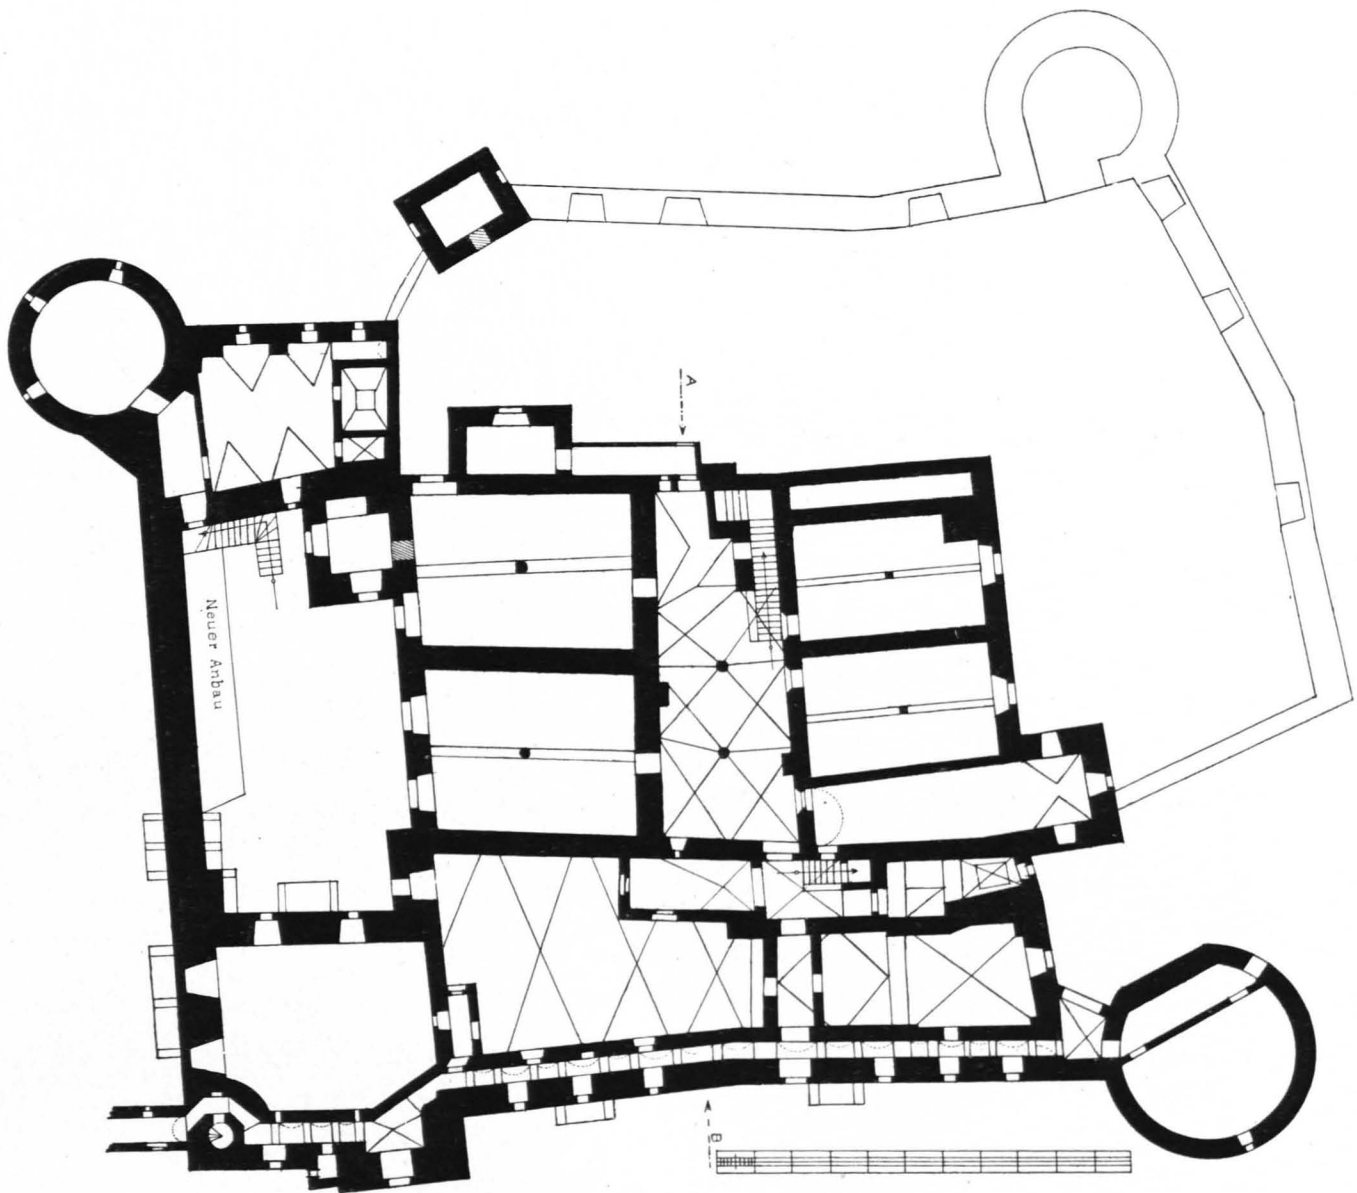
Hohensalzburg, altes Schloß, I. Stock, Grundriß 1 : 200 (S. 110)
